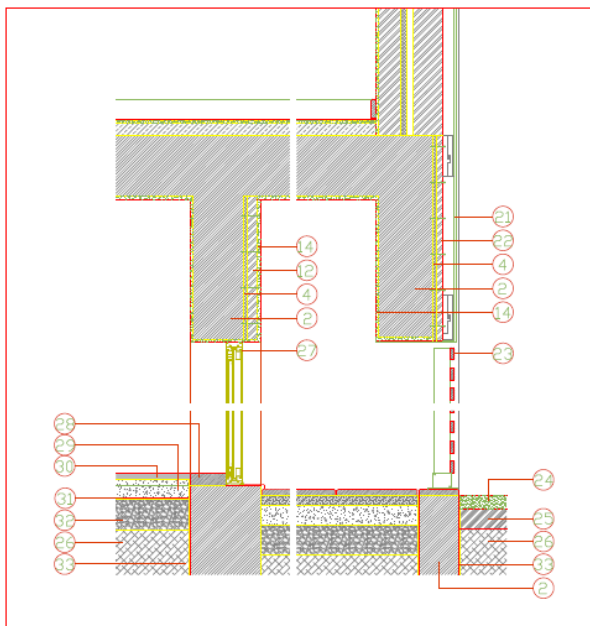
a) Pormenor construtivo do piso 1 corte V1.
